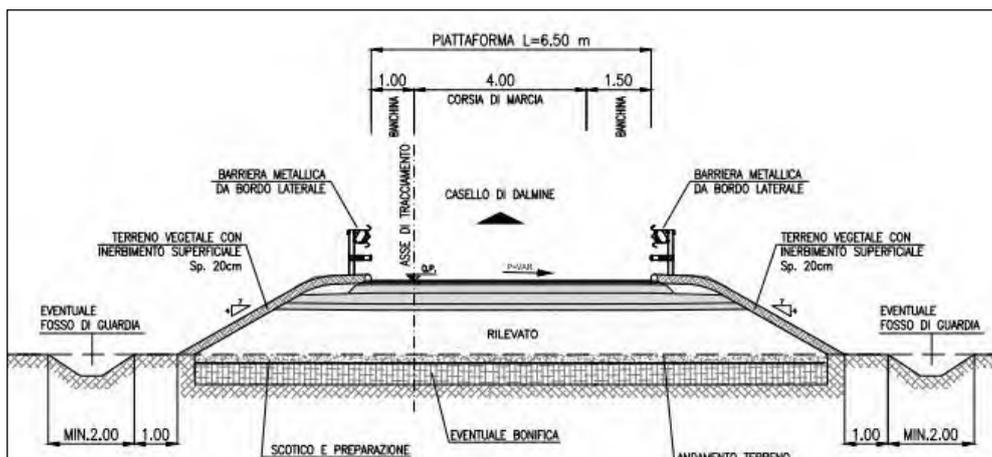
Sezione tipo rampa di svincolo monodirezionale
